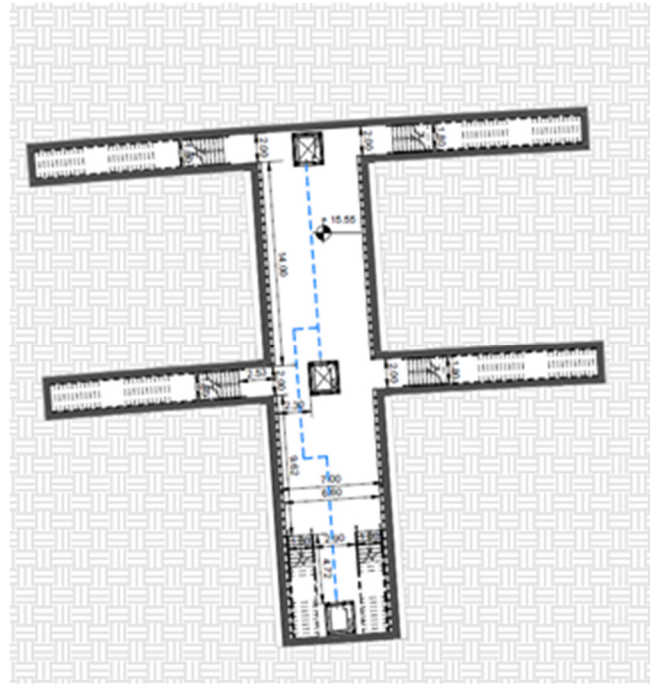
Pianta sottopasso di stazione (sezione di calcolo sottopasso)
